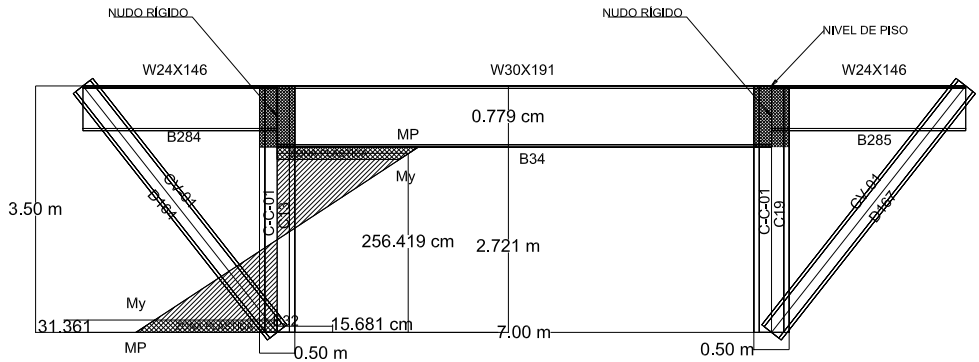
Marco aislado para el cálculo de las articulaciones en vigas
